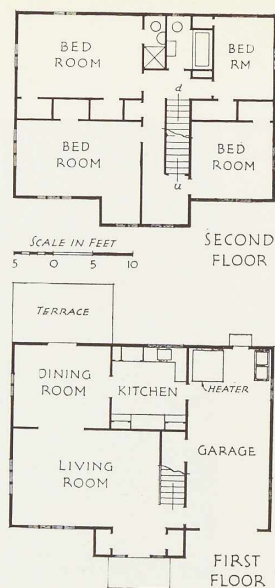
Vue en plan du rez-de-chaussée et du 1^{er} étage de la maison de l'American Rolling Mill Cy.
